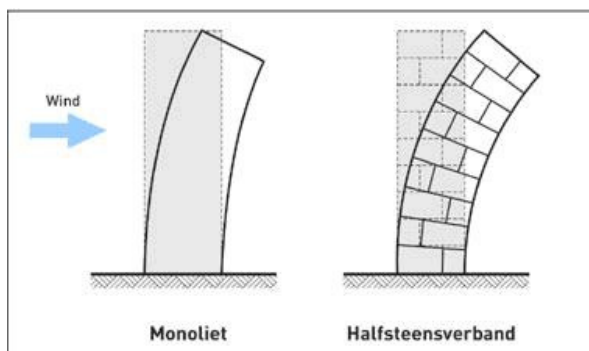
Overzicht constructiesystemen. Bron: opgenomen in diverse publicaties.
